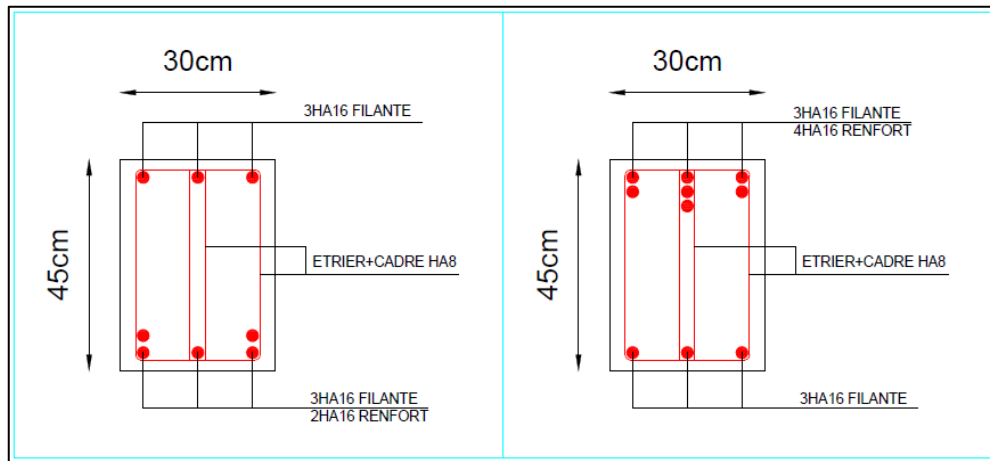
Ferrailage des poutres principales (30×45) cm selon le calcul à L’E.L.ACC sur travée et appui.
